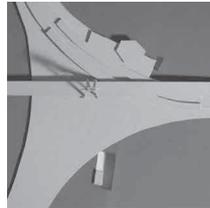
Grundrisskizze des Bahnhofsgebäudes in seiner isolierten Lage am Weg vom Flughafen zu den Gleisen. Es wurde aufgrund geringen Publikumsverkehrs inzwischen geschlossen.
